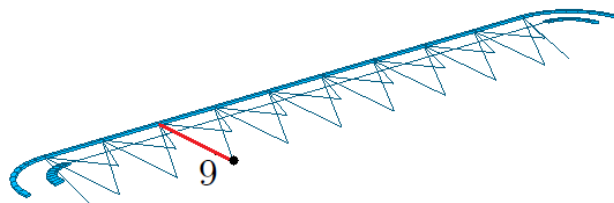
Etude poussée d'un bracon travaillant dans le système de reprise de l'effort excentré induit par la poutre de roulement.
